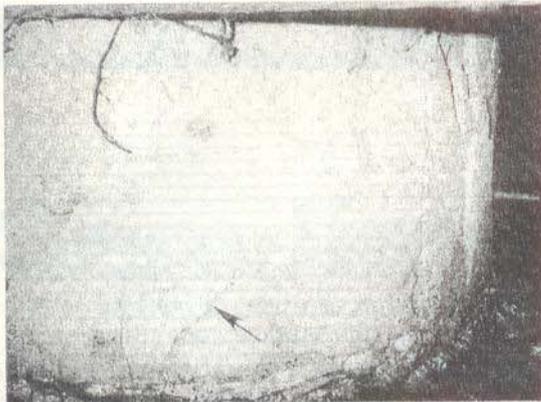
Um pilar curto e rígido, entre a laje da rampa e o piso, com sinais de graves danos.
